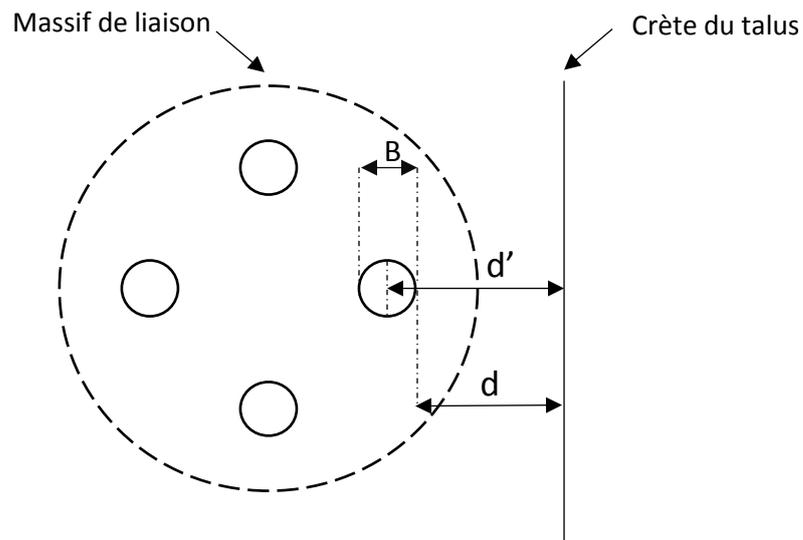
Fondation profonde multipieux établie à proximité d'un talus (vue en plan)
